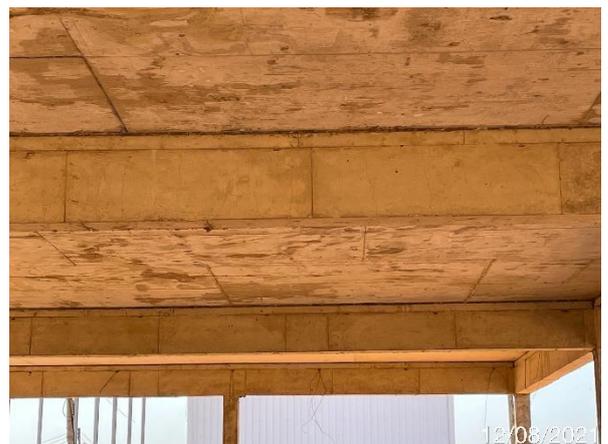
Marcas de forma no concreto e presença de fissuras por toda a laje e viga (Data da imagem: 12/08/2021)
